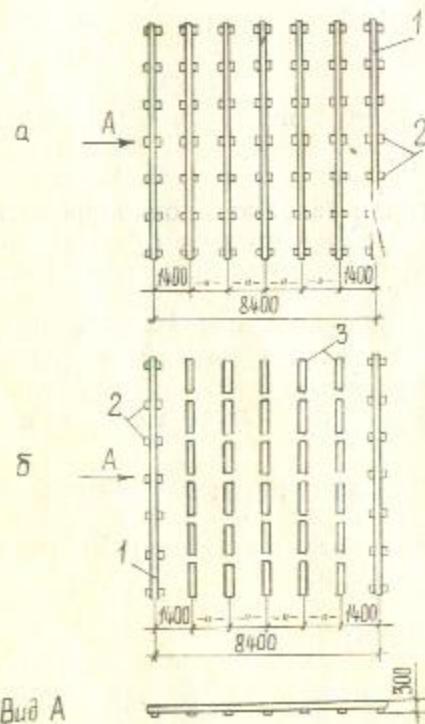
Схема подштабельных фундаментов для укладки пакетных штабелей краном в закрытом неотапливаемом складе (а) и автопогрузчиком под навесом (б):
